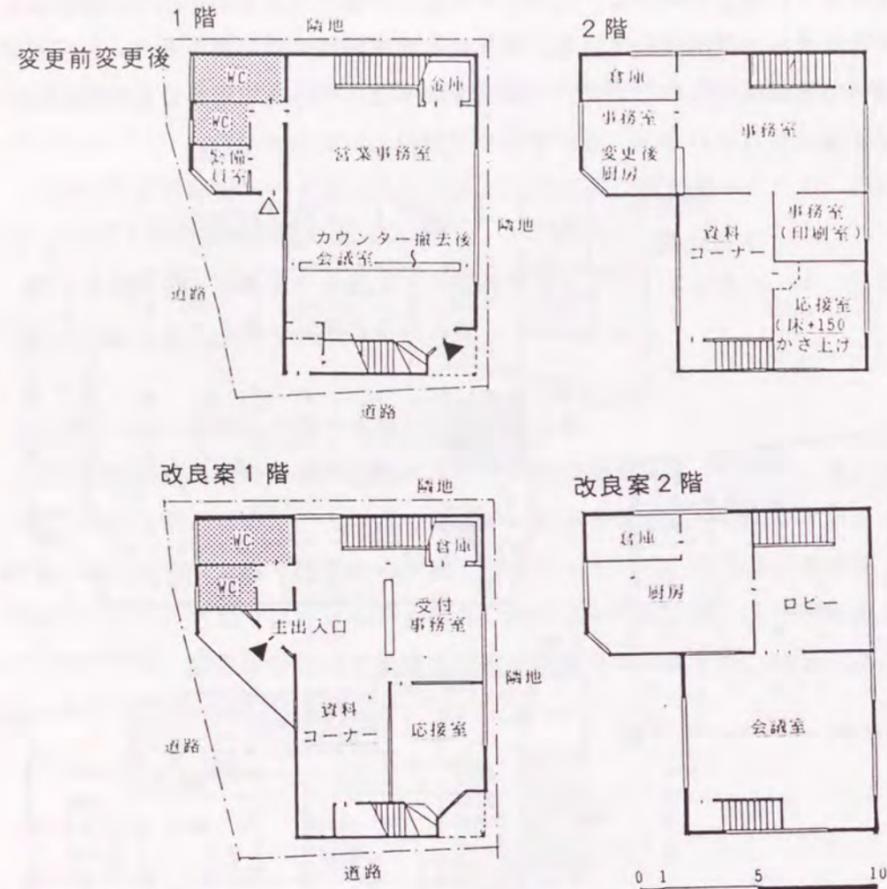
<113>日野市婦人センター（旧市指定銀行）平面図
